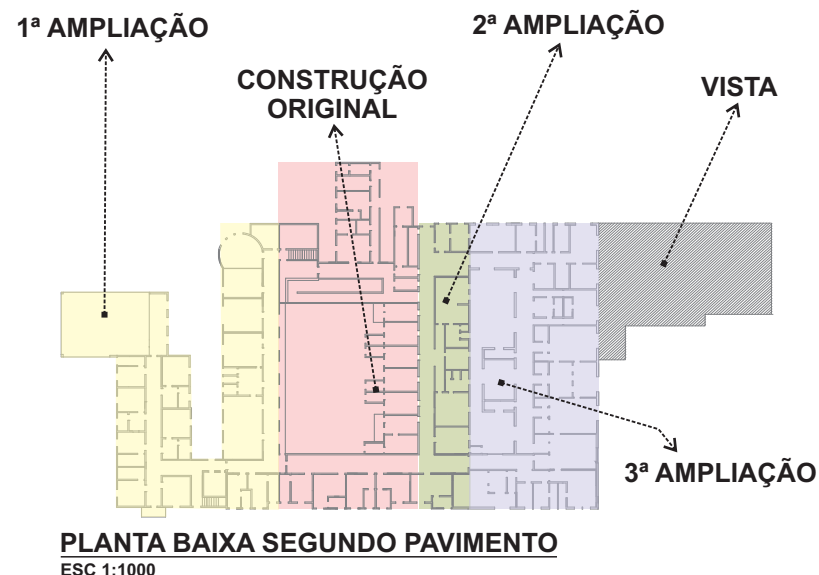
Planta Baixa do segundo pavimento do Hospital São Sebastião. Nela, estão identificadas a área original de implantação junto com as outras três ampliações sofridas pelo hospital no pavimento posterior. Fonte: Autor.
